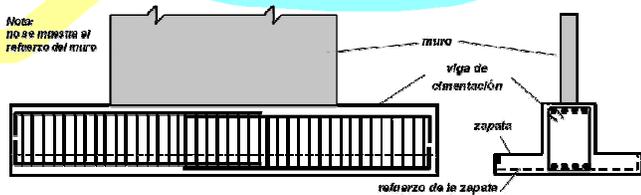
Refuerzo de zapata de muro y viga de cimentación
